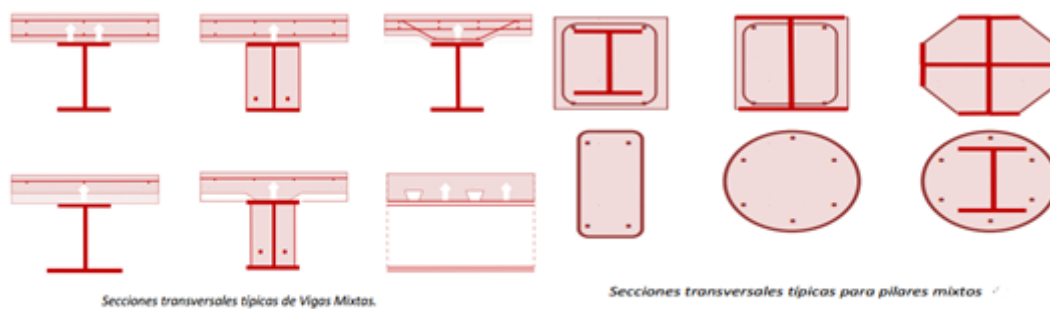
Secciones transversales Vigas y Pilares Mixtos
